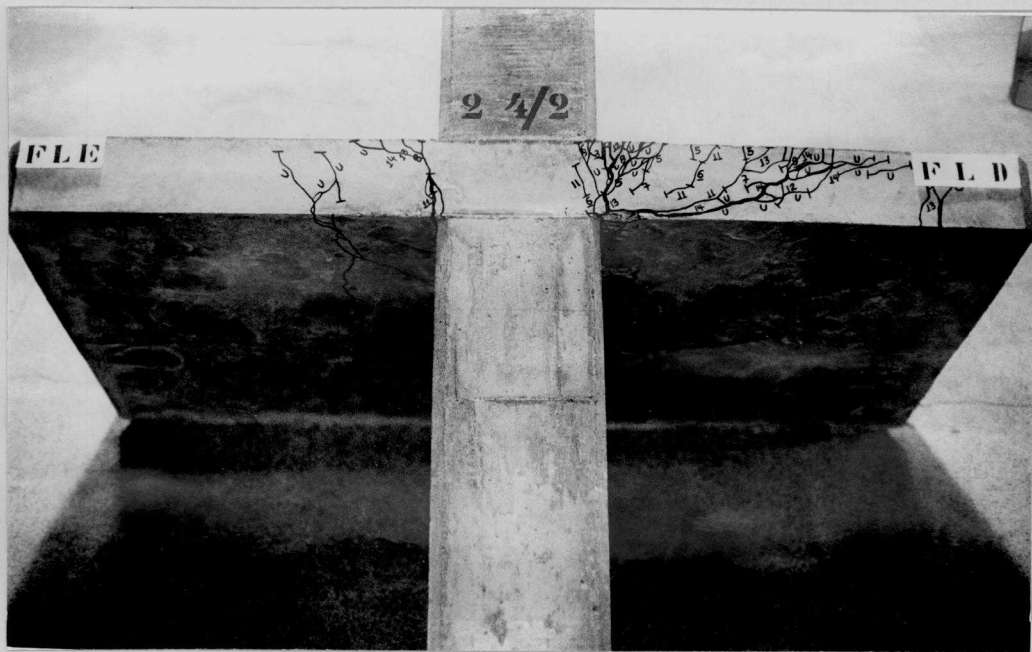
b - Fissuração na face lateral do modelo EdL 24/2.
